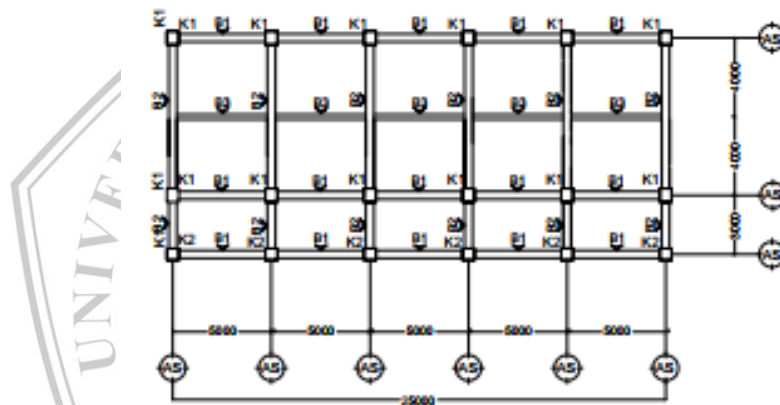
Rencana Balok dan Kolom Lantai 4
